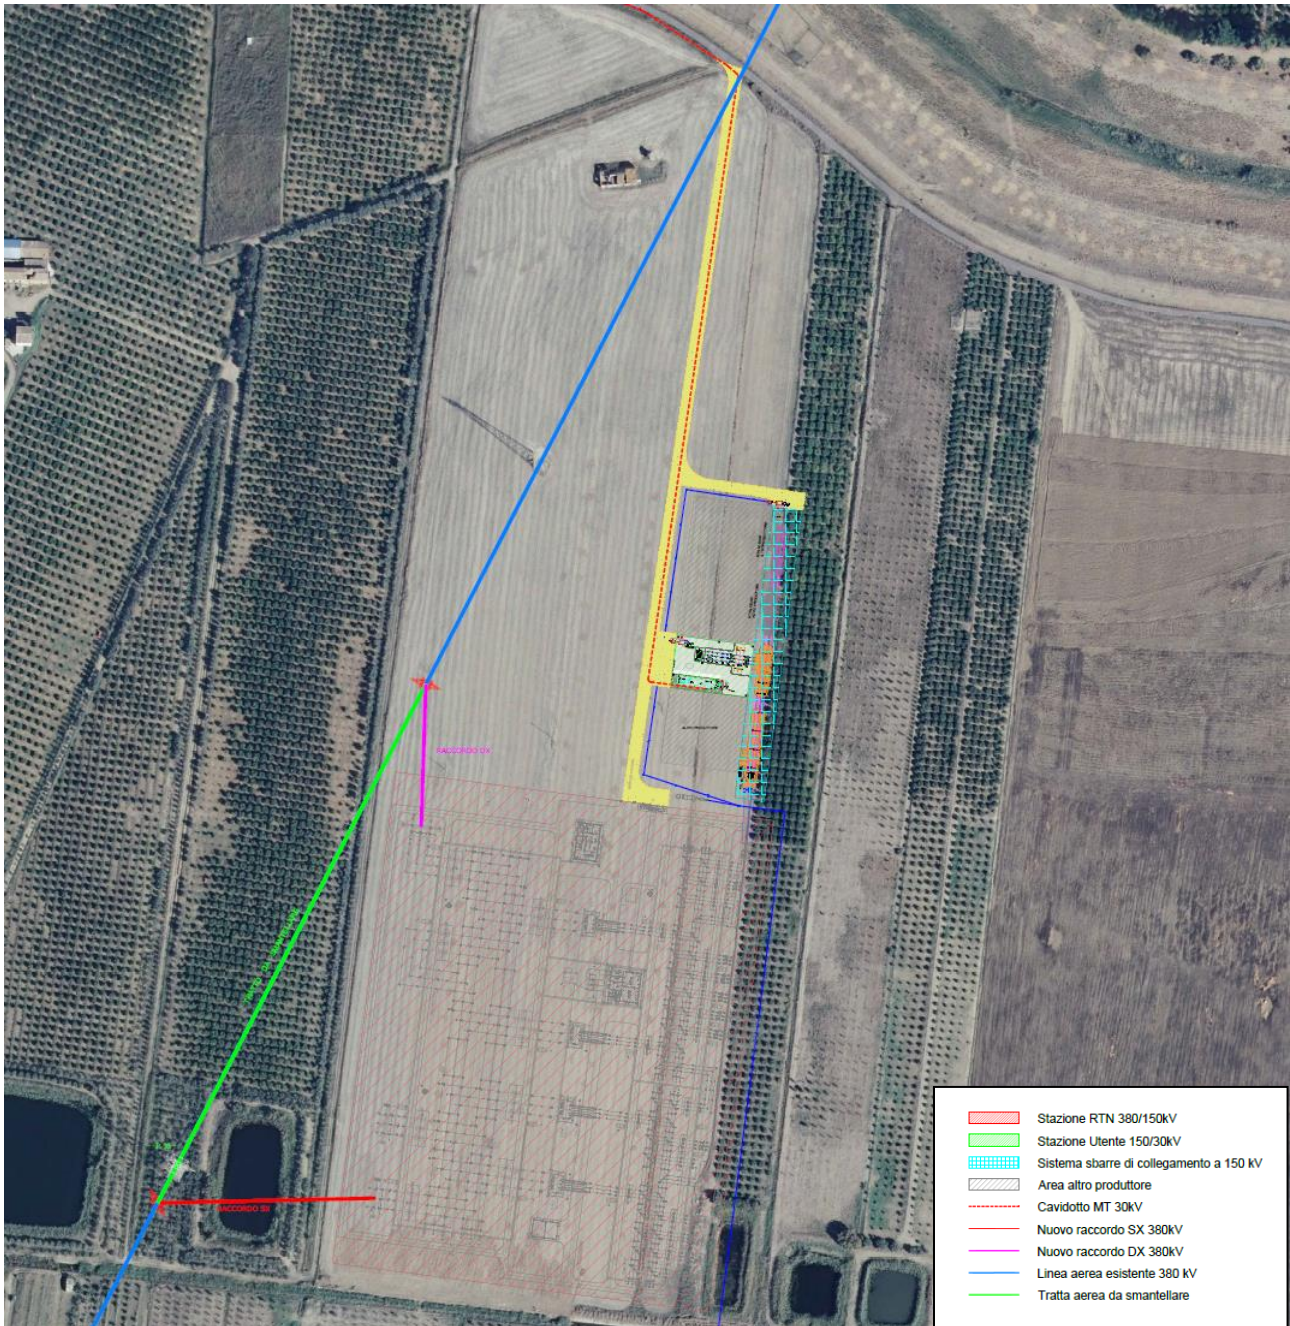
Lay out generale Impianto di Utente e Impianto di Rete
